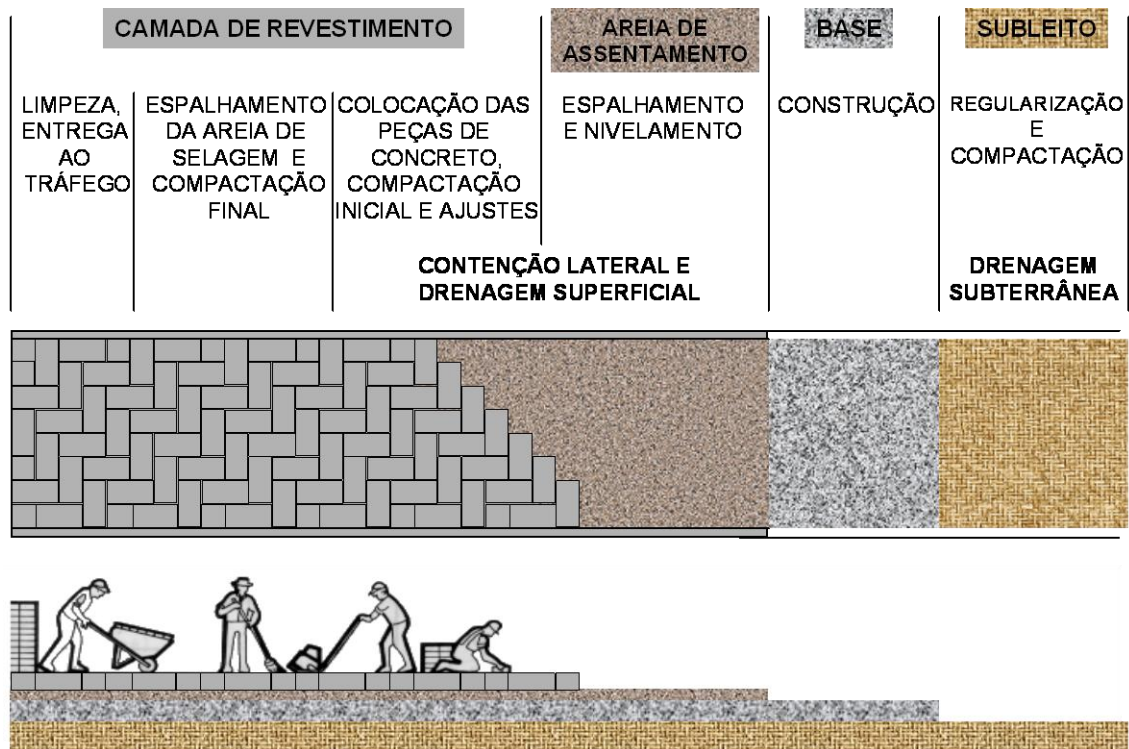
Procedimento de construção. (MADRID & LONDOÑO, 1986).
